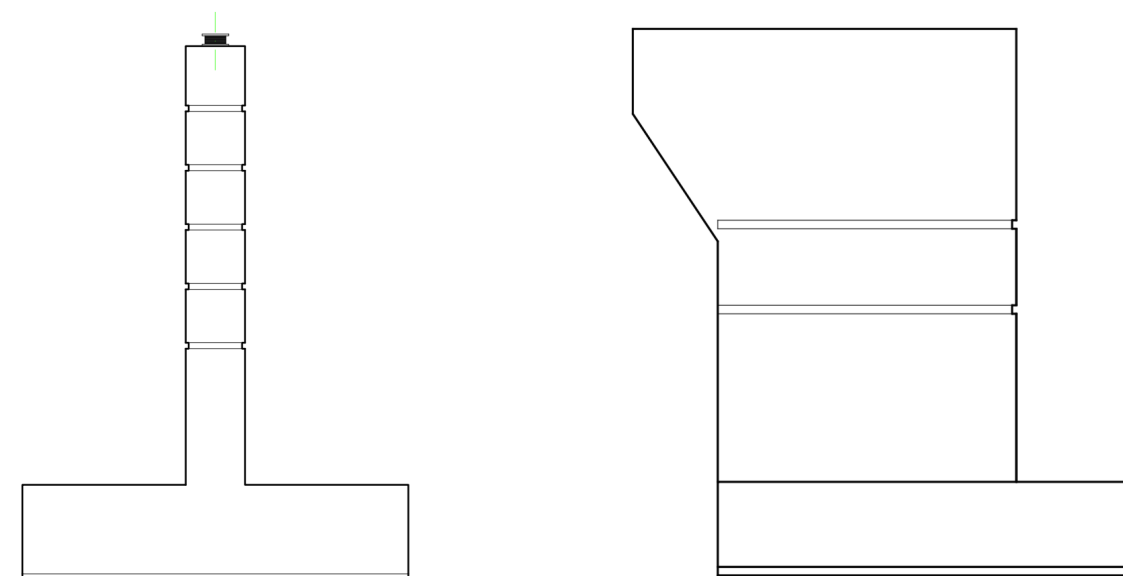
a. Alzado longitudinal de la pila y del estribo.
